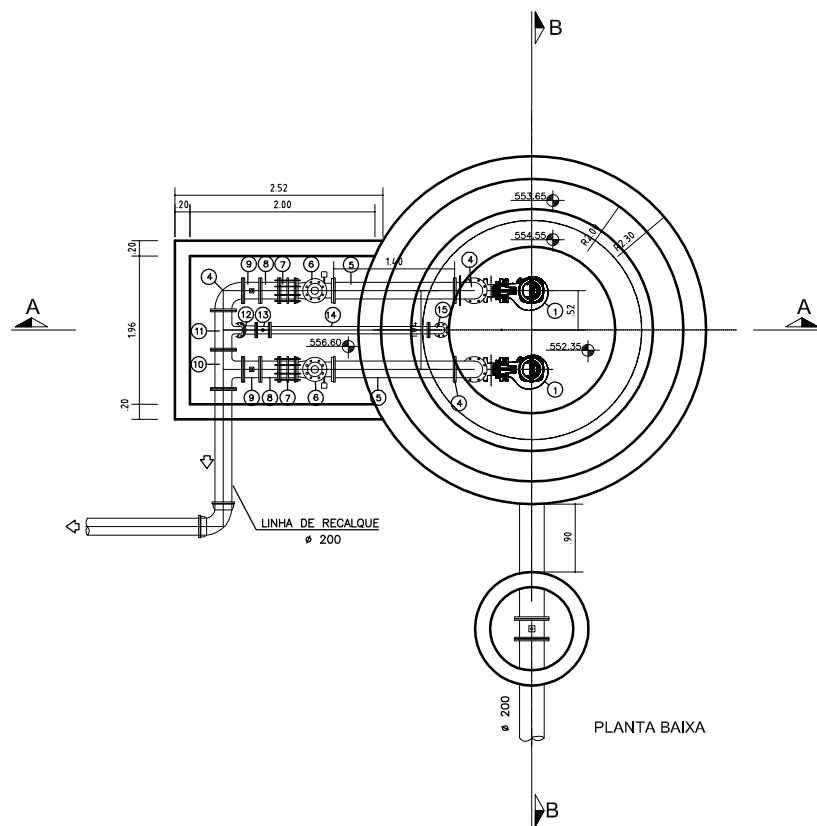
PLANTA GERAL DO SISTEMA
